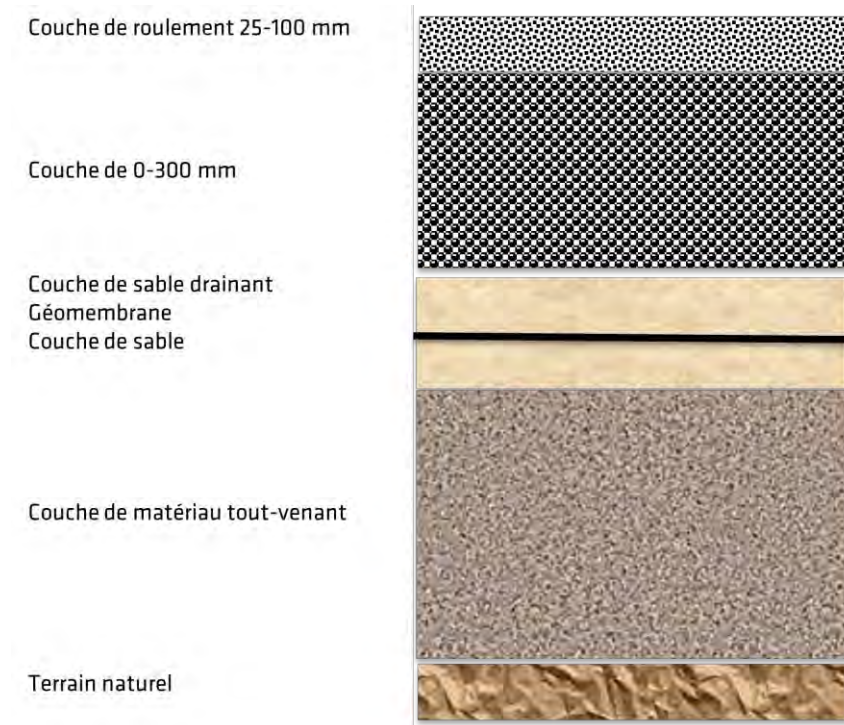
Coupe transversale de la structure de la chaussée de la route de halage
